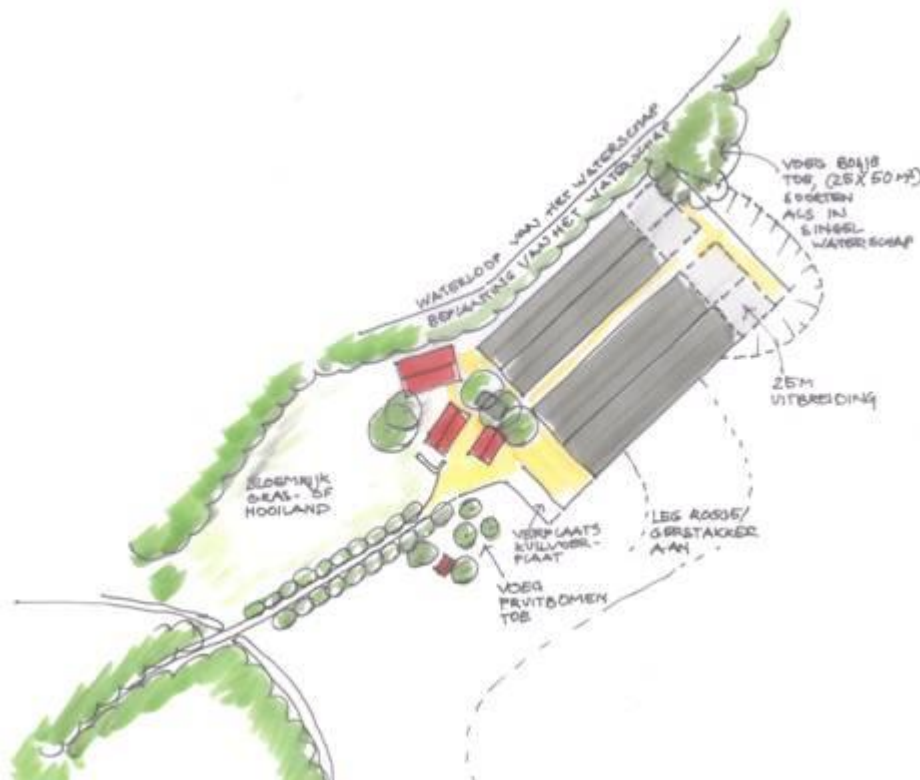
Bovenaanzicht gewenste situatie (Bron: Pit Bouwadvies)
